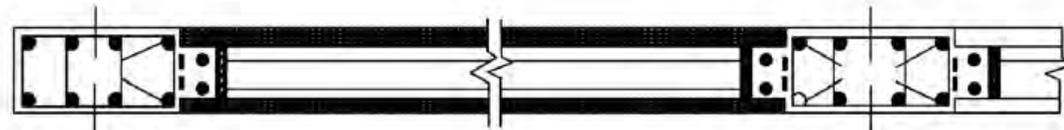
Конструкция каркаса открытых универсальных архитектурно-строительных систем зданий: 1 — несущие ригели; 2 — колонны; 3 — консоли для устройства балконов, эркеров; 4 — многопустотные плиты; 5 — связевые ригели
